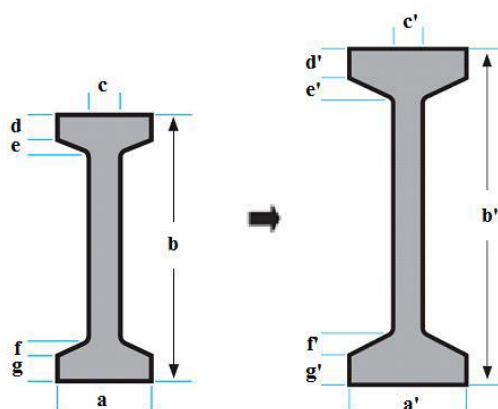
Exemplo de aplicação de otimização paramétrica (adaptado). Fonte: Archi Expo.
